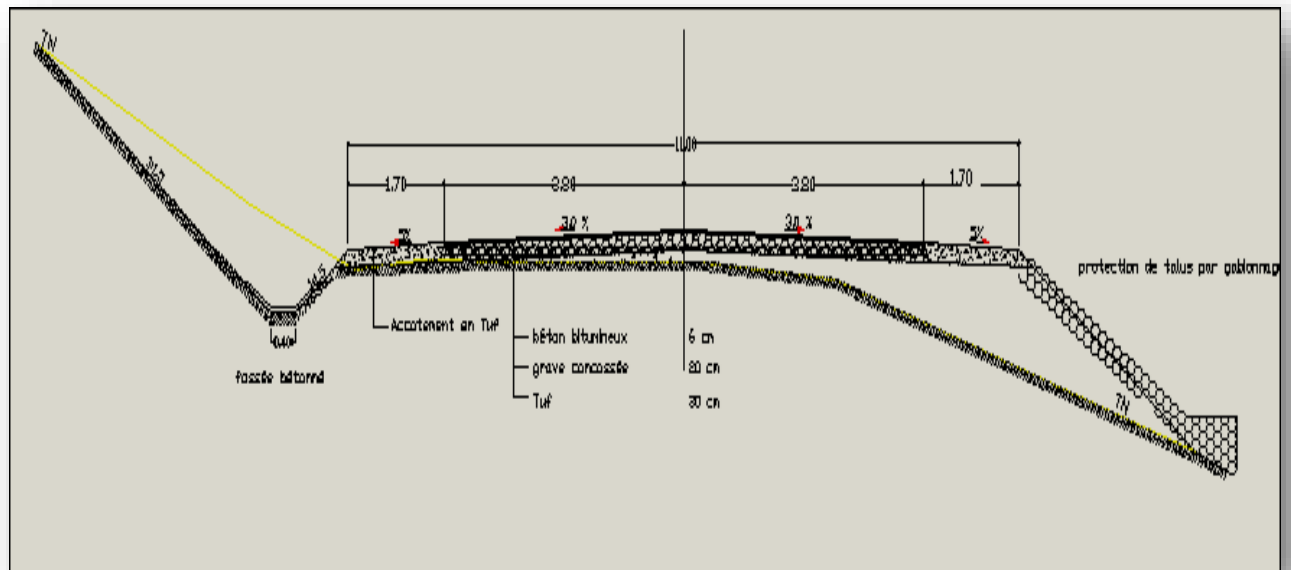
15 : profil en travers type en mixte de la RN 94.
